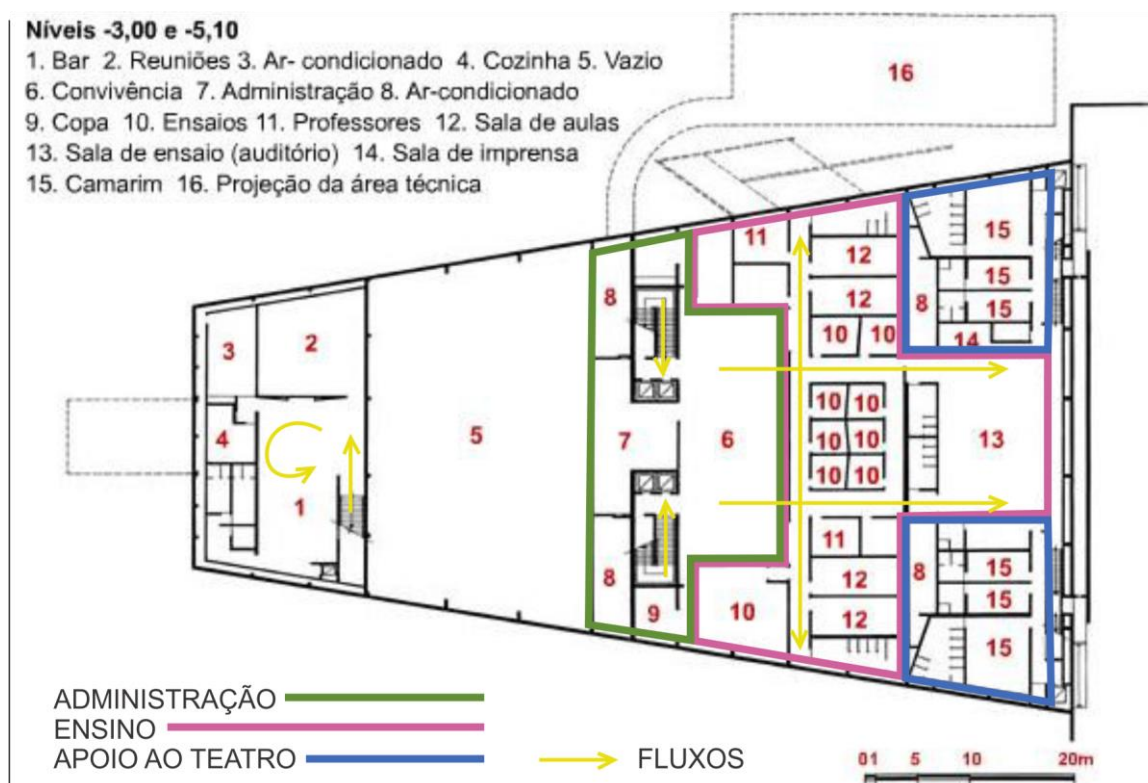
Planta baixa subsolo, Auditório do Parque Ibirapuera
